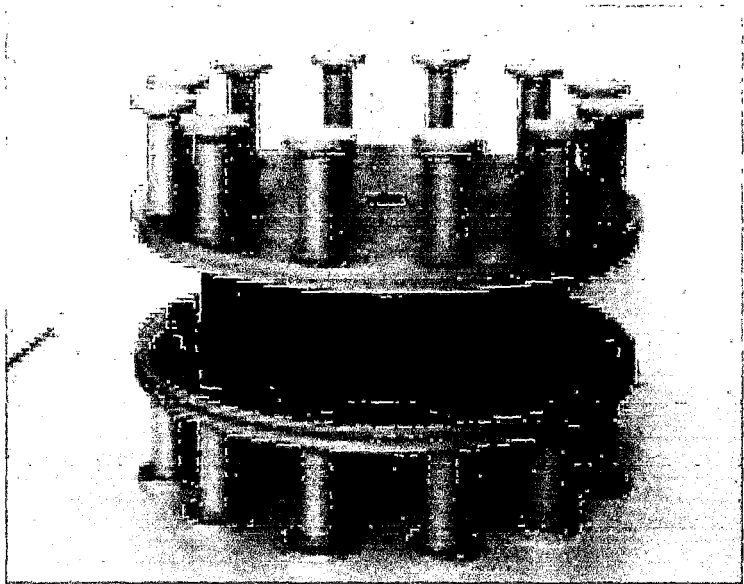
Aislador tipo LDR version actual con refuerzos de laminas de acero.
